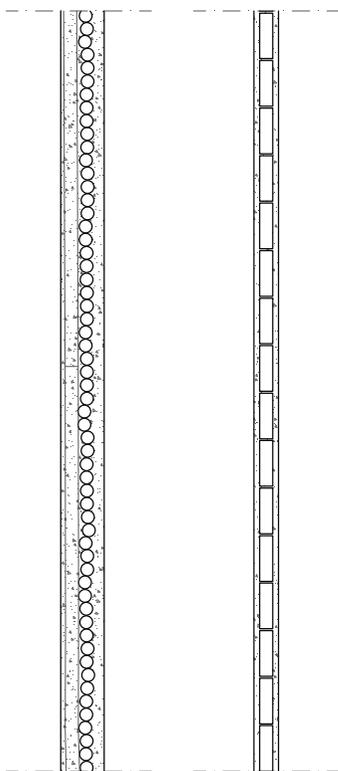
Detalles constructivos de los tipos de tabiquería.
